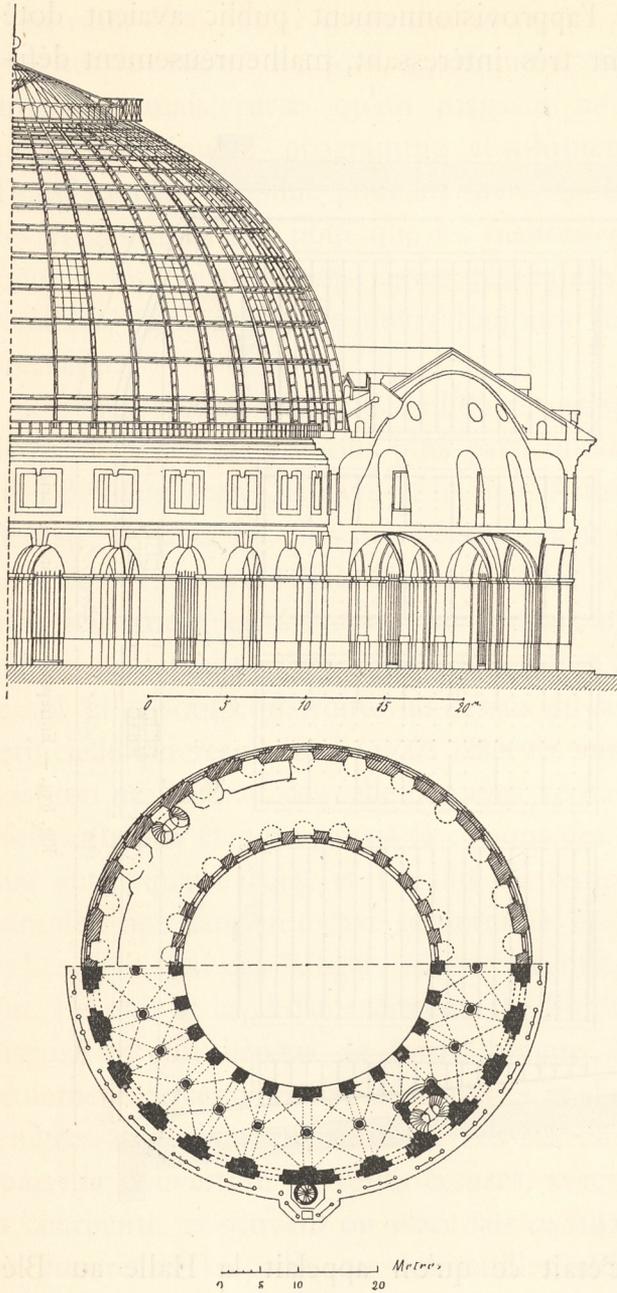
Ancienne halle au blé de Paris. Coupe et plan.
